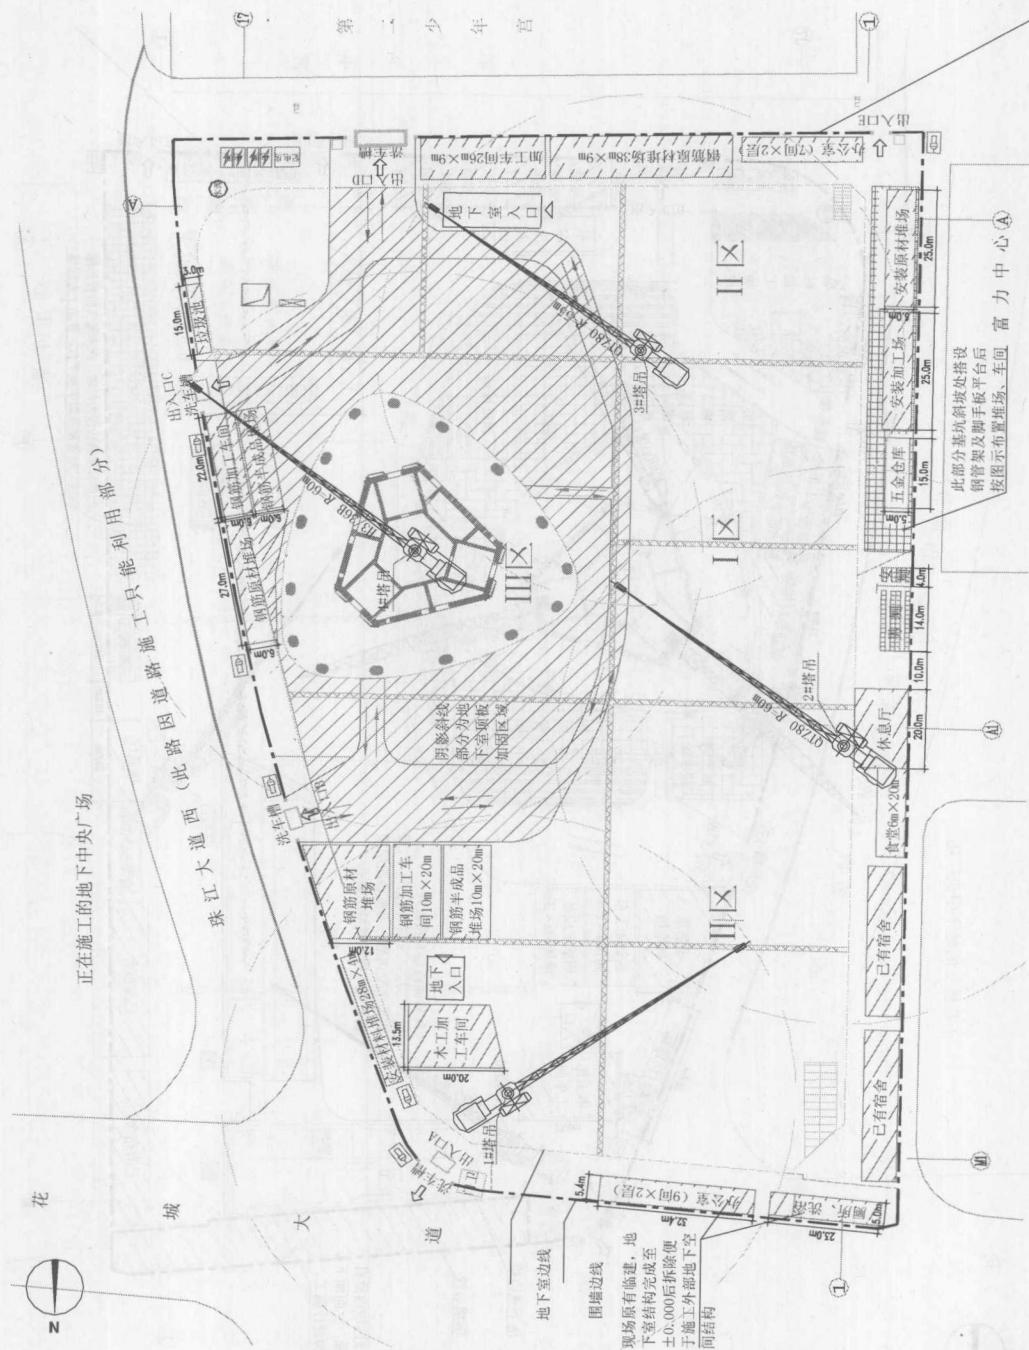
地下室结构与主体交叉施工阶段平面布置图
